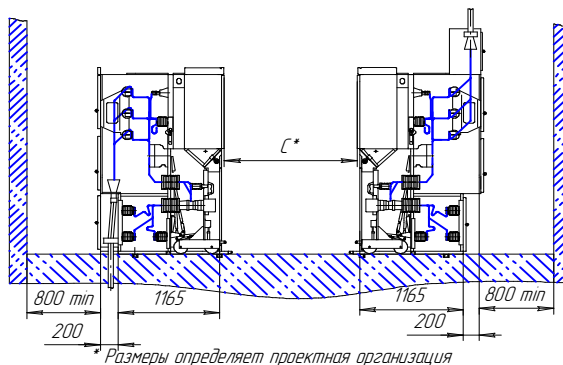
Установка шкафов с кабельным вводом снизу внутри и с кабельным вводом сверху на фундамент
